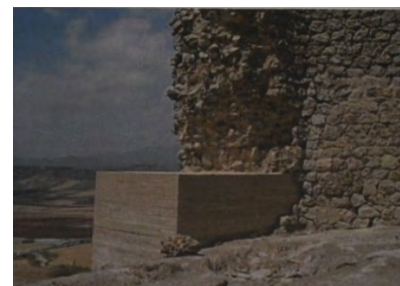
Relleno de grietas del lienzo de muralla a base de hormigón rehundido y reconstrucción torre. (Jurado 2013)
